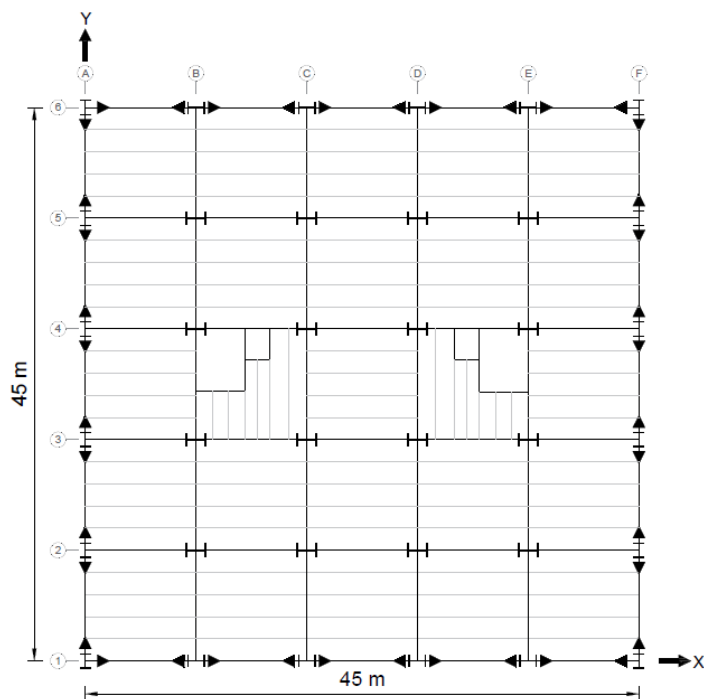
Planta de edificaciones analizadas (Estructura Tipo 2). [29]
